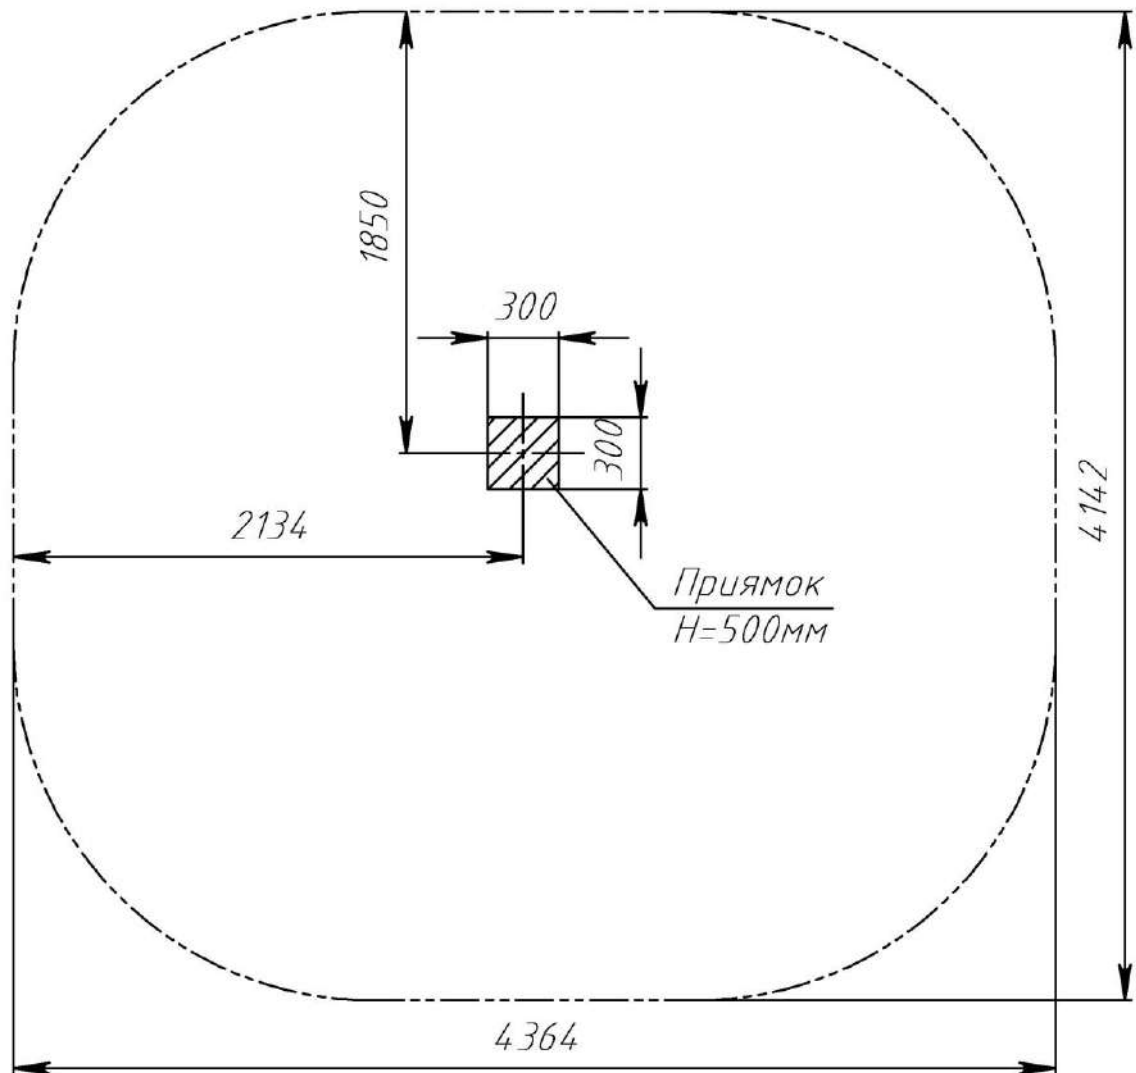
План фундамента тренажера "Гиперэкстензия + пресс" РТР 504Т
